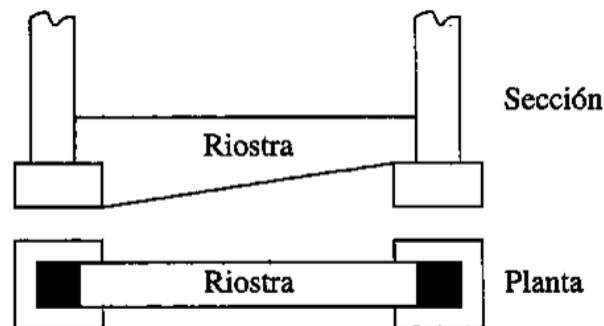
Zapata en voladizo: uso de viga de arriostamiento (Das, 2012).
